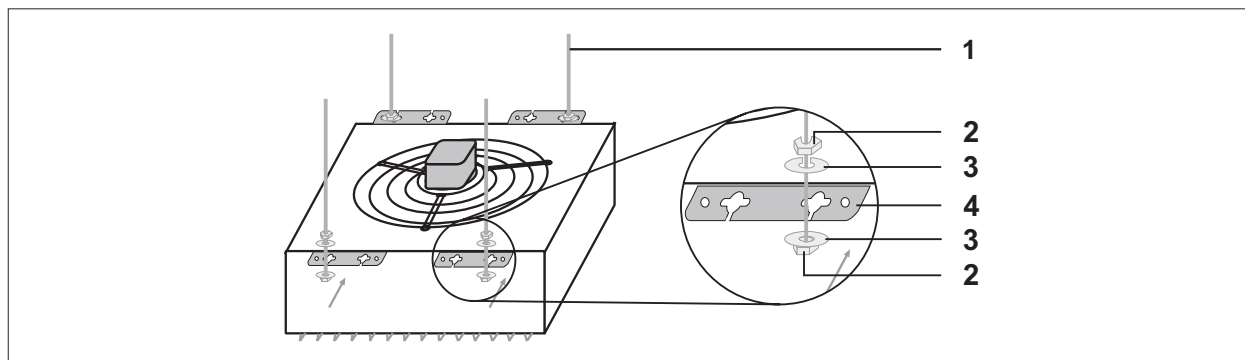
Потолочный монтаж воздухонагревателя с вертикальным направлением воздуха
